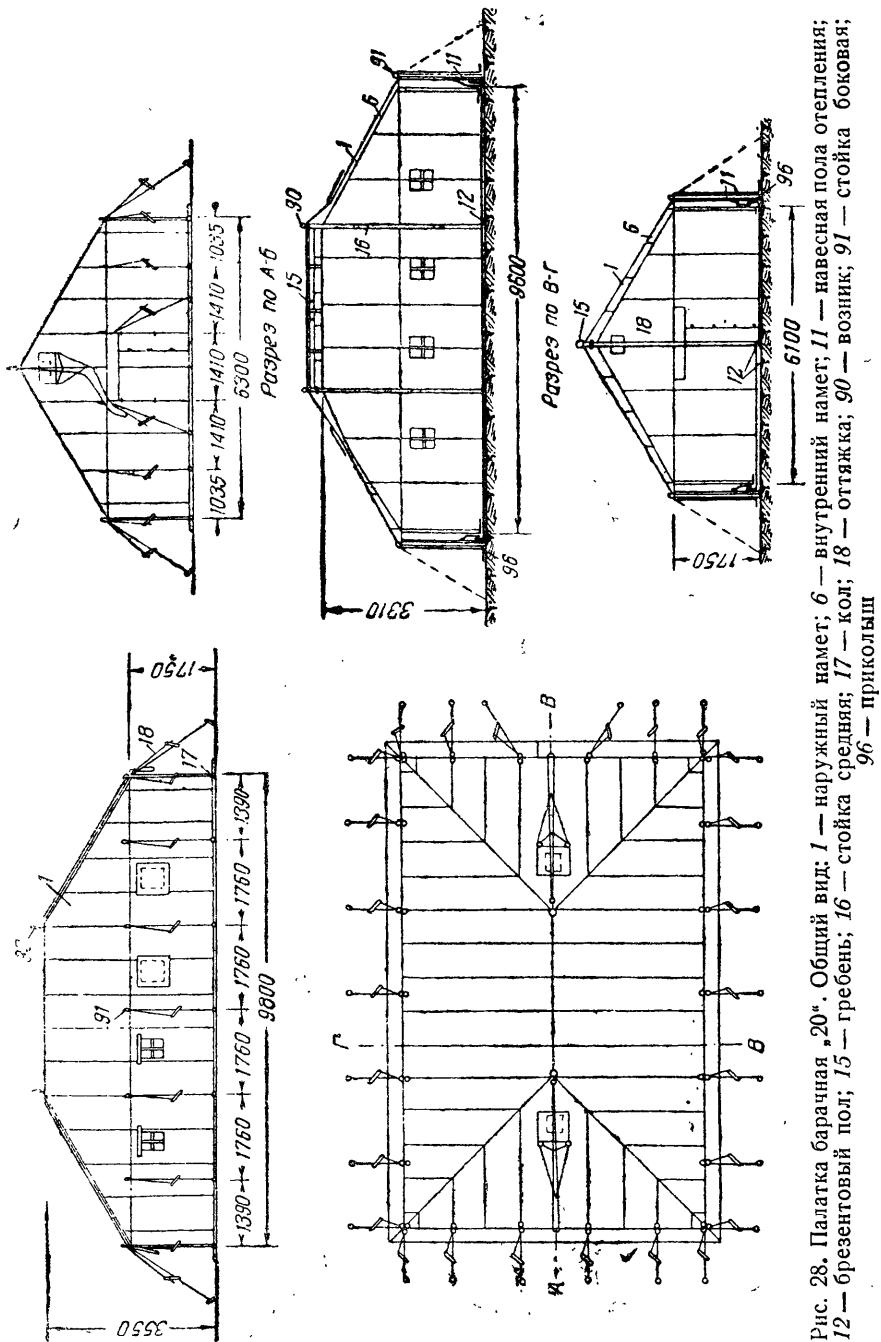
Палатка барачная "20". Общий вид; 1 — наружный намет; 6 — внутренний намет; II — навесная пола отопления; 12 — брезентовый пол; 15 — гребень; 16 — стойка средняя; 17 — кол; 18 — оттяжка; 90 — возник; 91 — стойка боковая; 96 — приколыны
